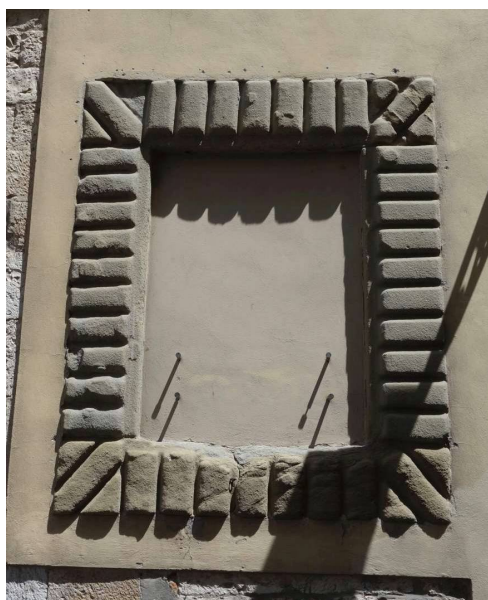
Linteau avec faux-appareil en bossage, imitant des joints verticaux, sur la façade d'un palais de Prato
